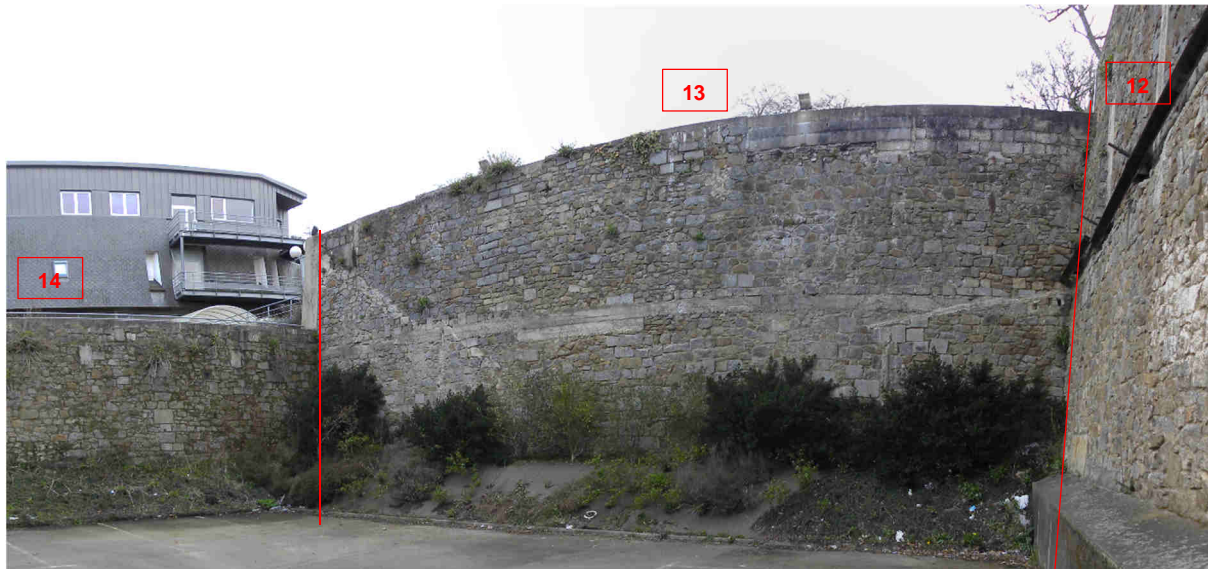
Mur N°13, Vue d'ensemble depuis la parcelle 546
